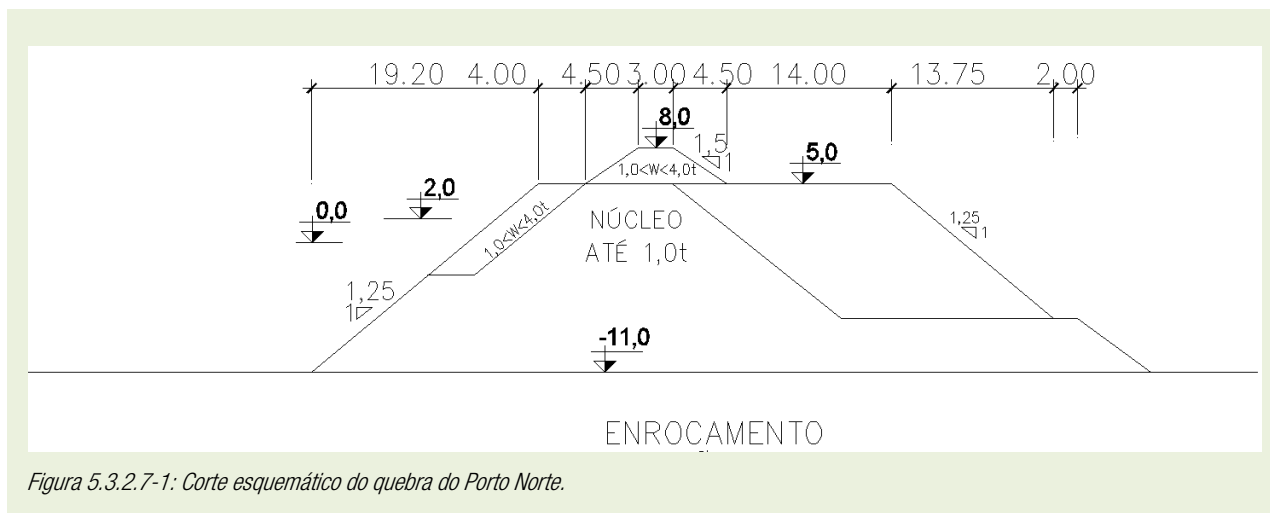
Corte esquemático do quebra do Porto Norte.
